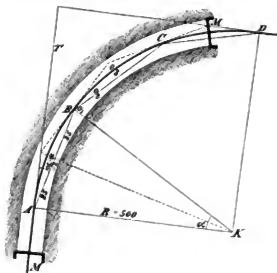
Absteckung der gekrümmten Tunnelachse<sup>3)</sup>.
